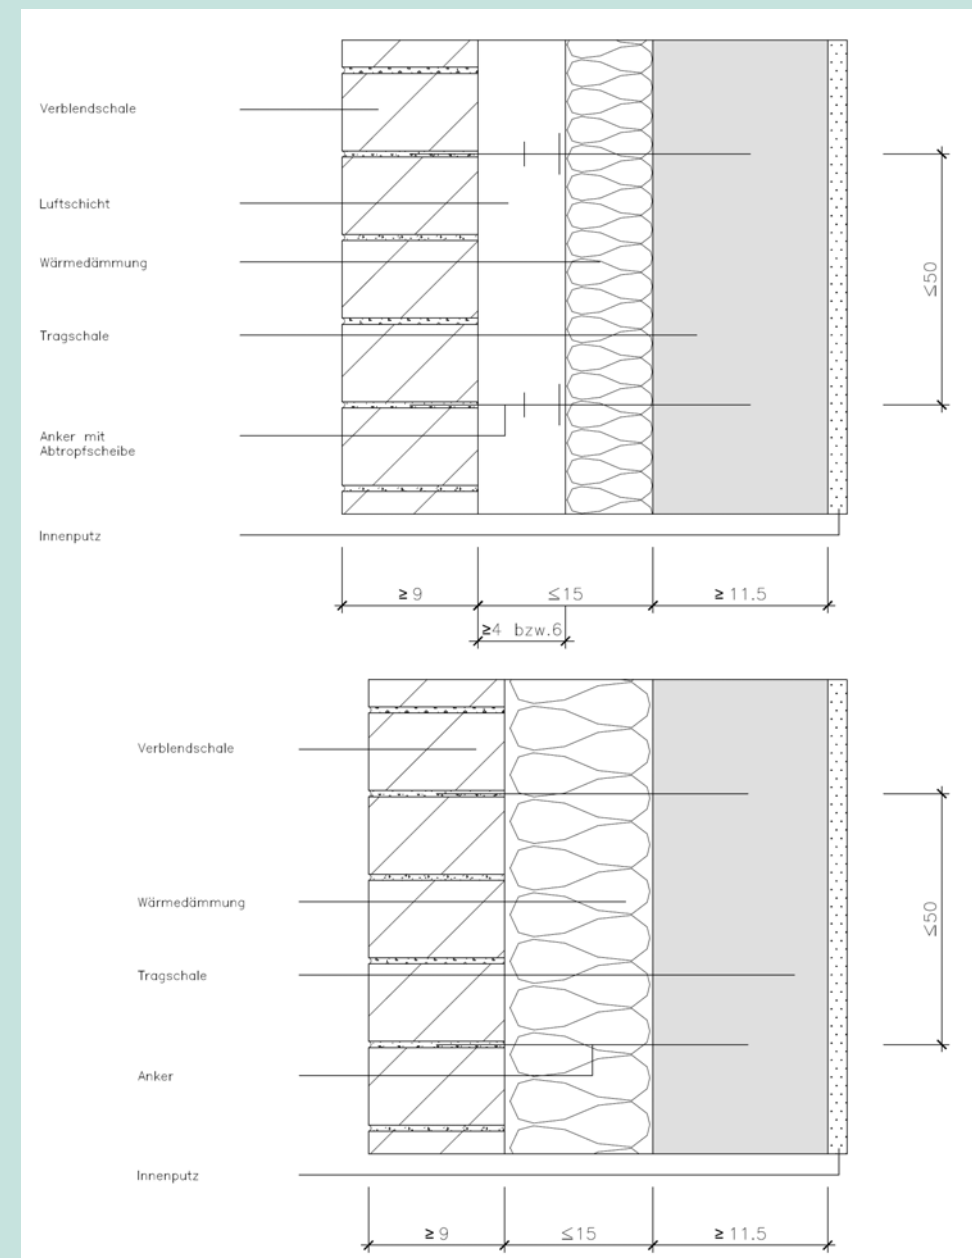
Zweischalige Außenwand mit Wärmedämmung und Luftschicht(o), mit Kerndämmung(u)
